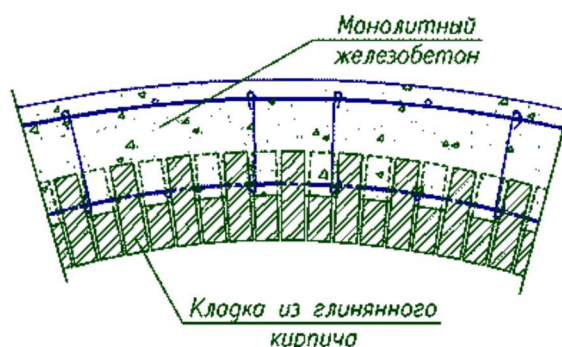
Схема конструктивного решения по устройству смешанной кирпично-железобетонной арки моста
